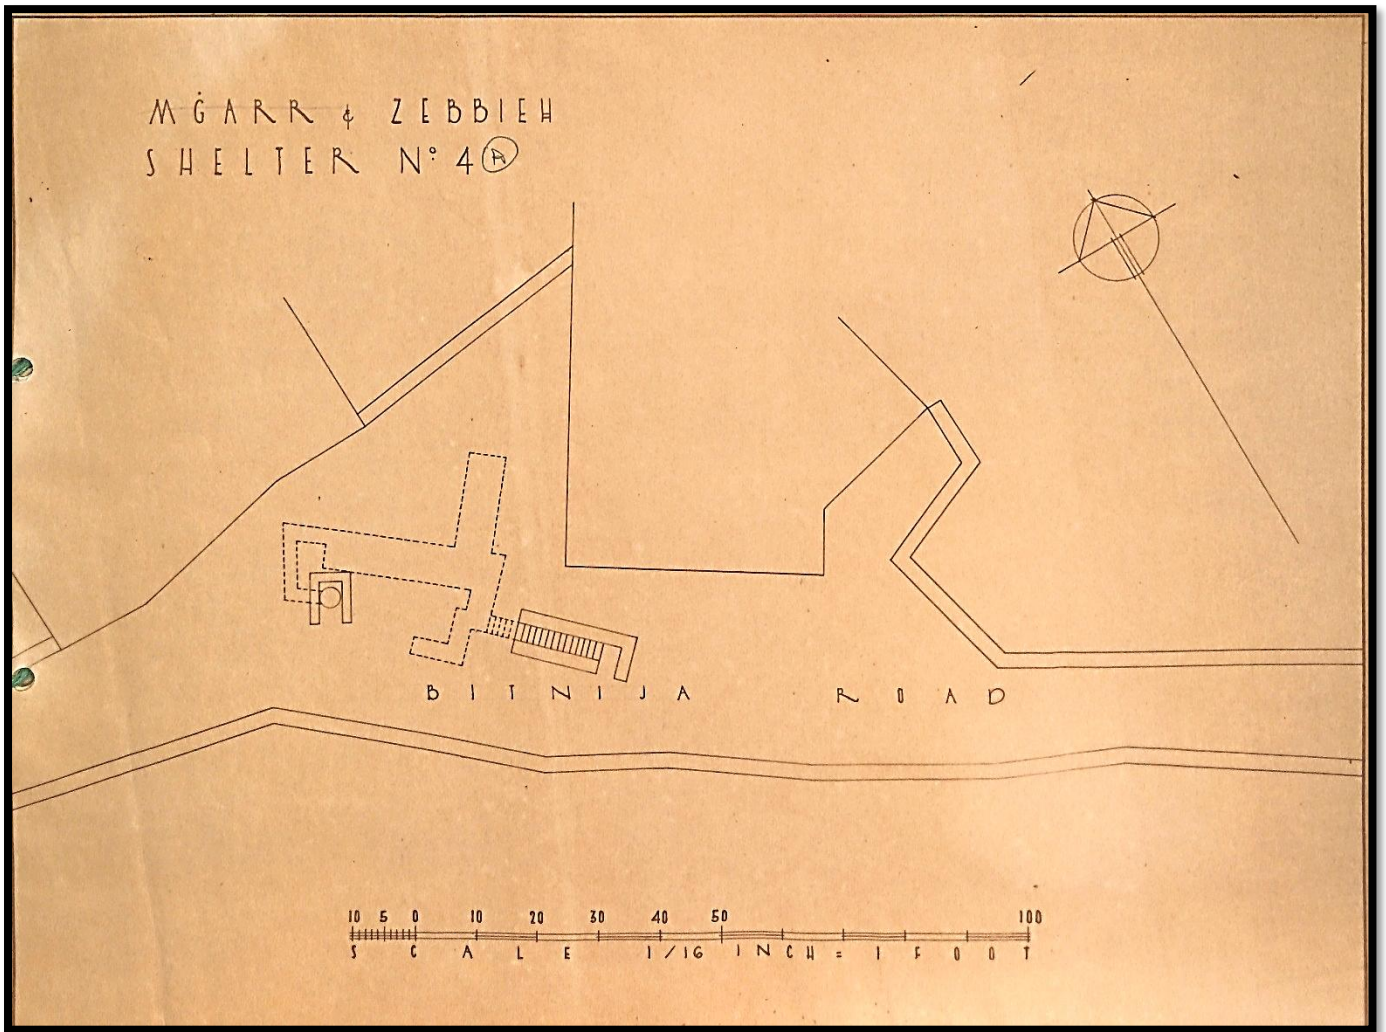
Planta do Abrigo nº4A "Blinija Road"
